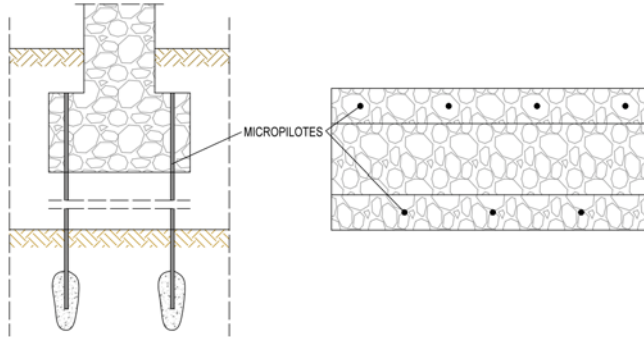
Refuerzo 1 mediante micropilotes de zapata corrida bajo muro. Fuente propia.
